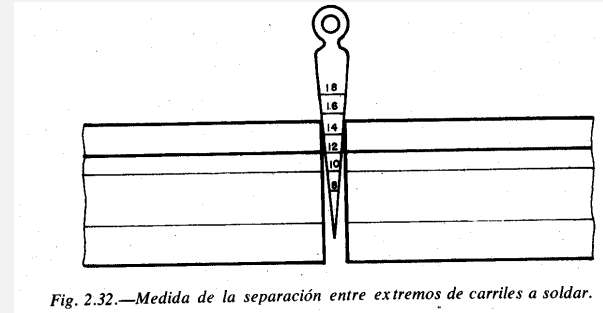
Medida de la separación entre extremos de carriles a soldar.
